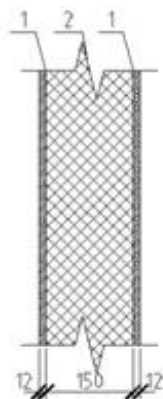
Расчетная схема ограждающих конструкций фасадов
